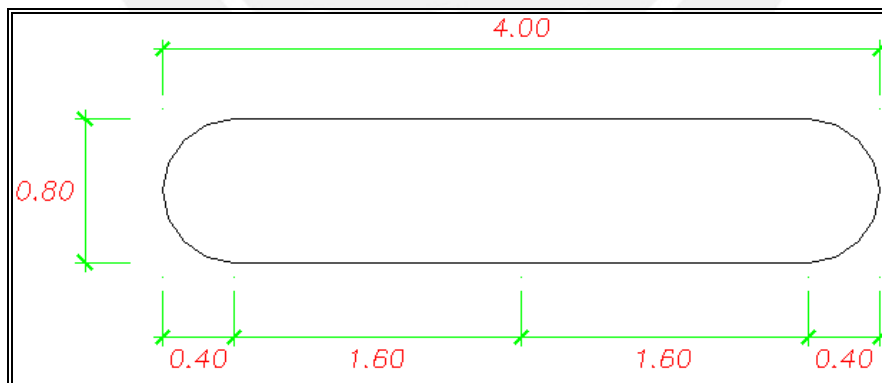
Sección Transversal de la subestructura del puente.
